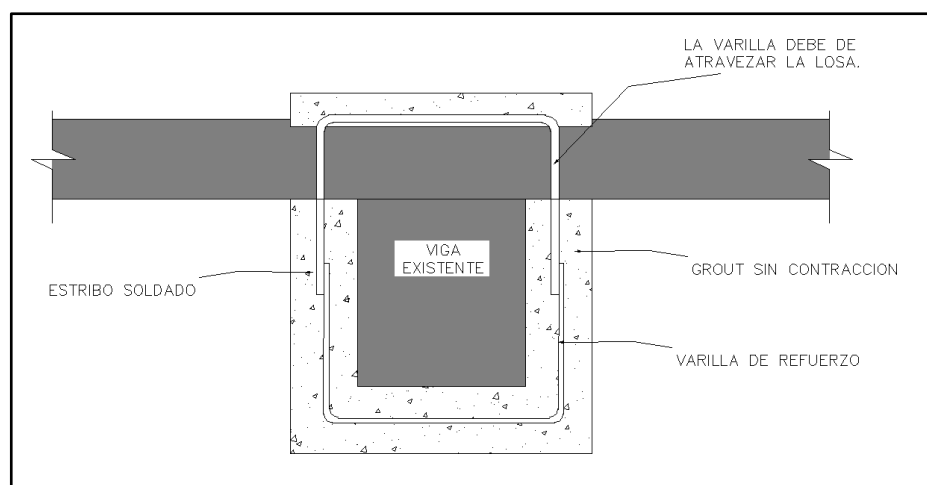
Detalle del encamisado de vigas de concreto reforzado
